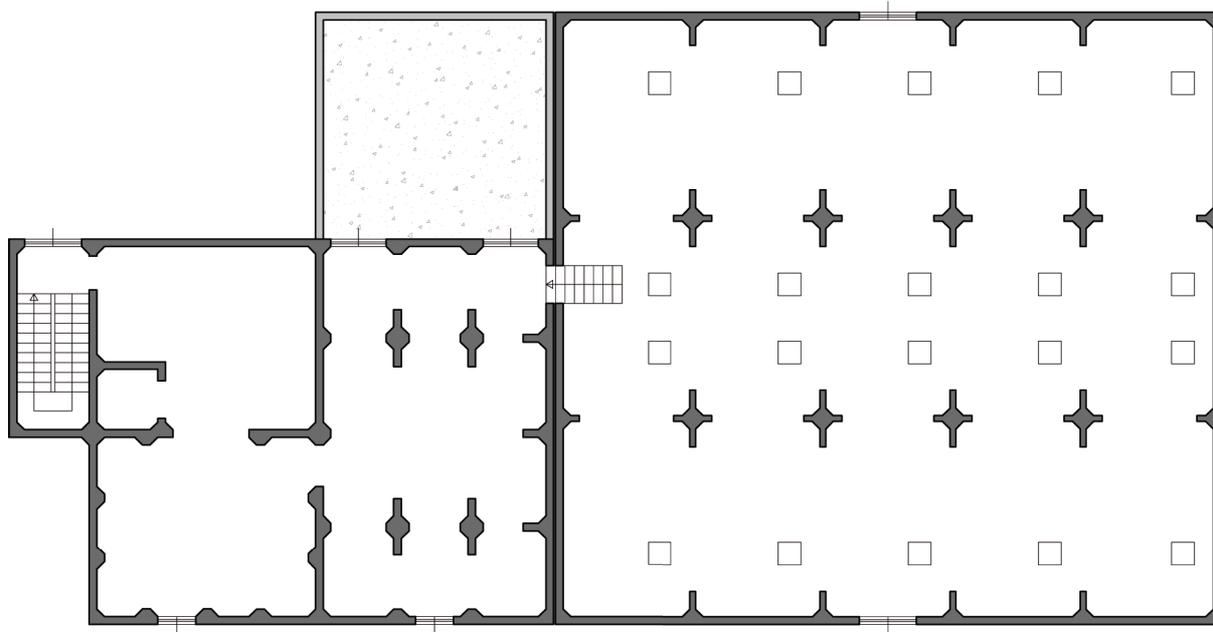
Bestandsplan - Grundriss 9. OG
